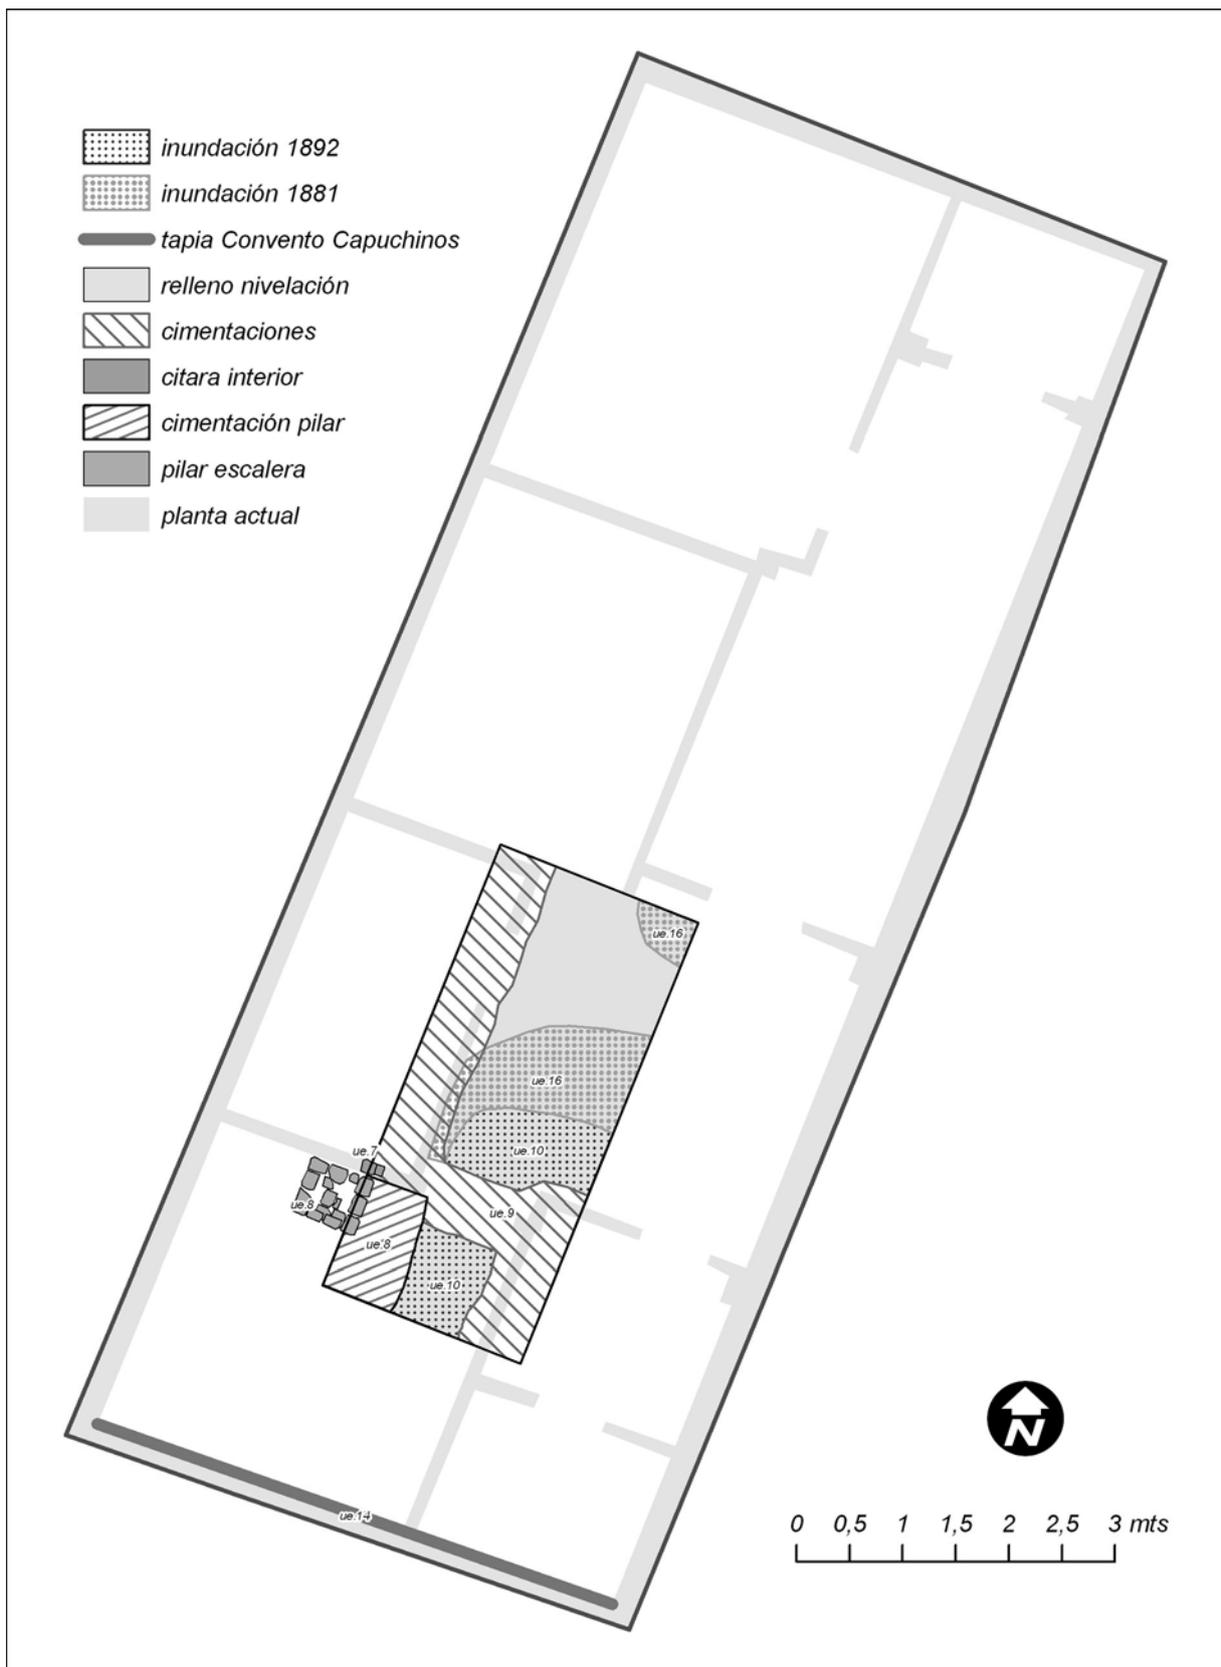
Estructuras arqueológicas documentadas en la Intervención
